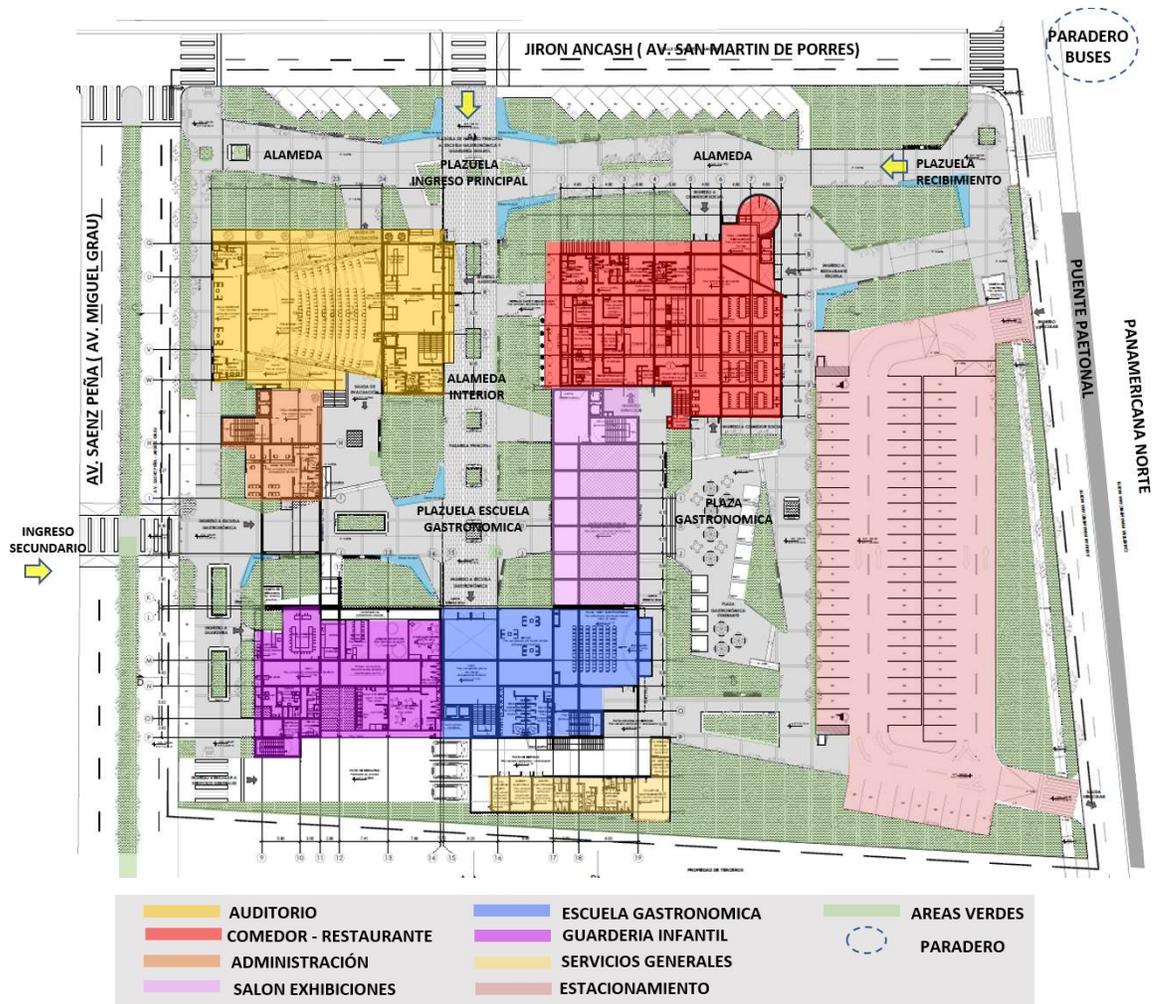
Plan Maestro del Proyecto de Escuela Gastronómica con Guardería Infantil en el distrito de Puente Piedra.
